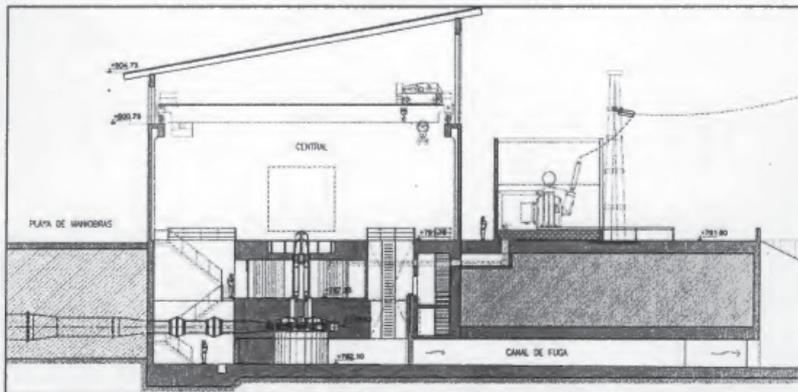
Planta y Corte de Central Hidroeléctrica
